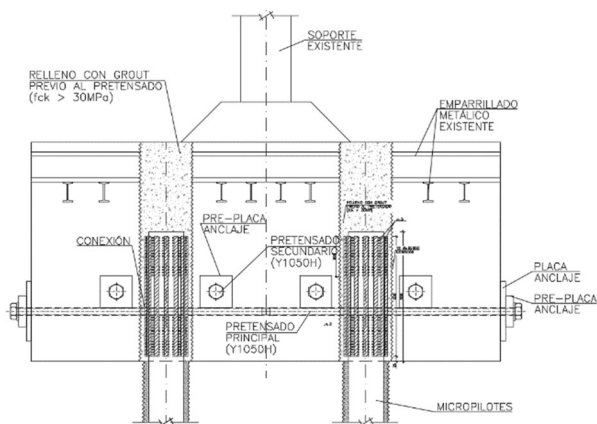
Detalle de transformación de zapata de hormigón en masa en encepado de micropilotes
